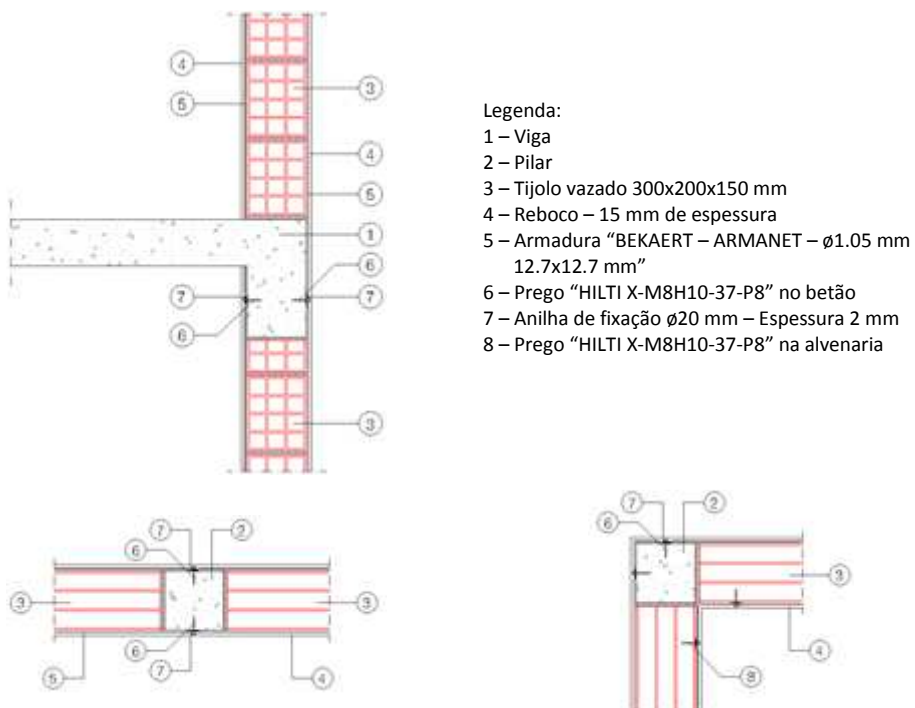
Armadura colocada nas paredes WALL_RAR.
